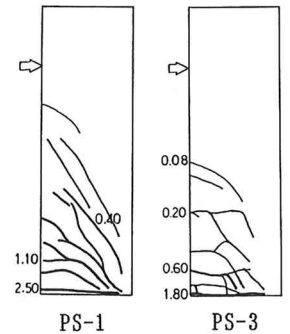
$4\delta_y$ 載荷時のひび割れ状況
